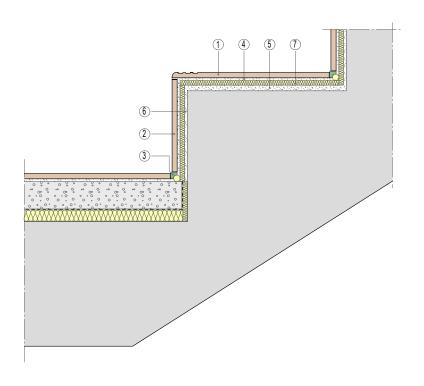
Escalier en béton coulé en place avec marches acoustiquement isolées
